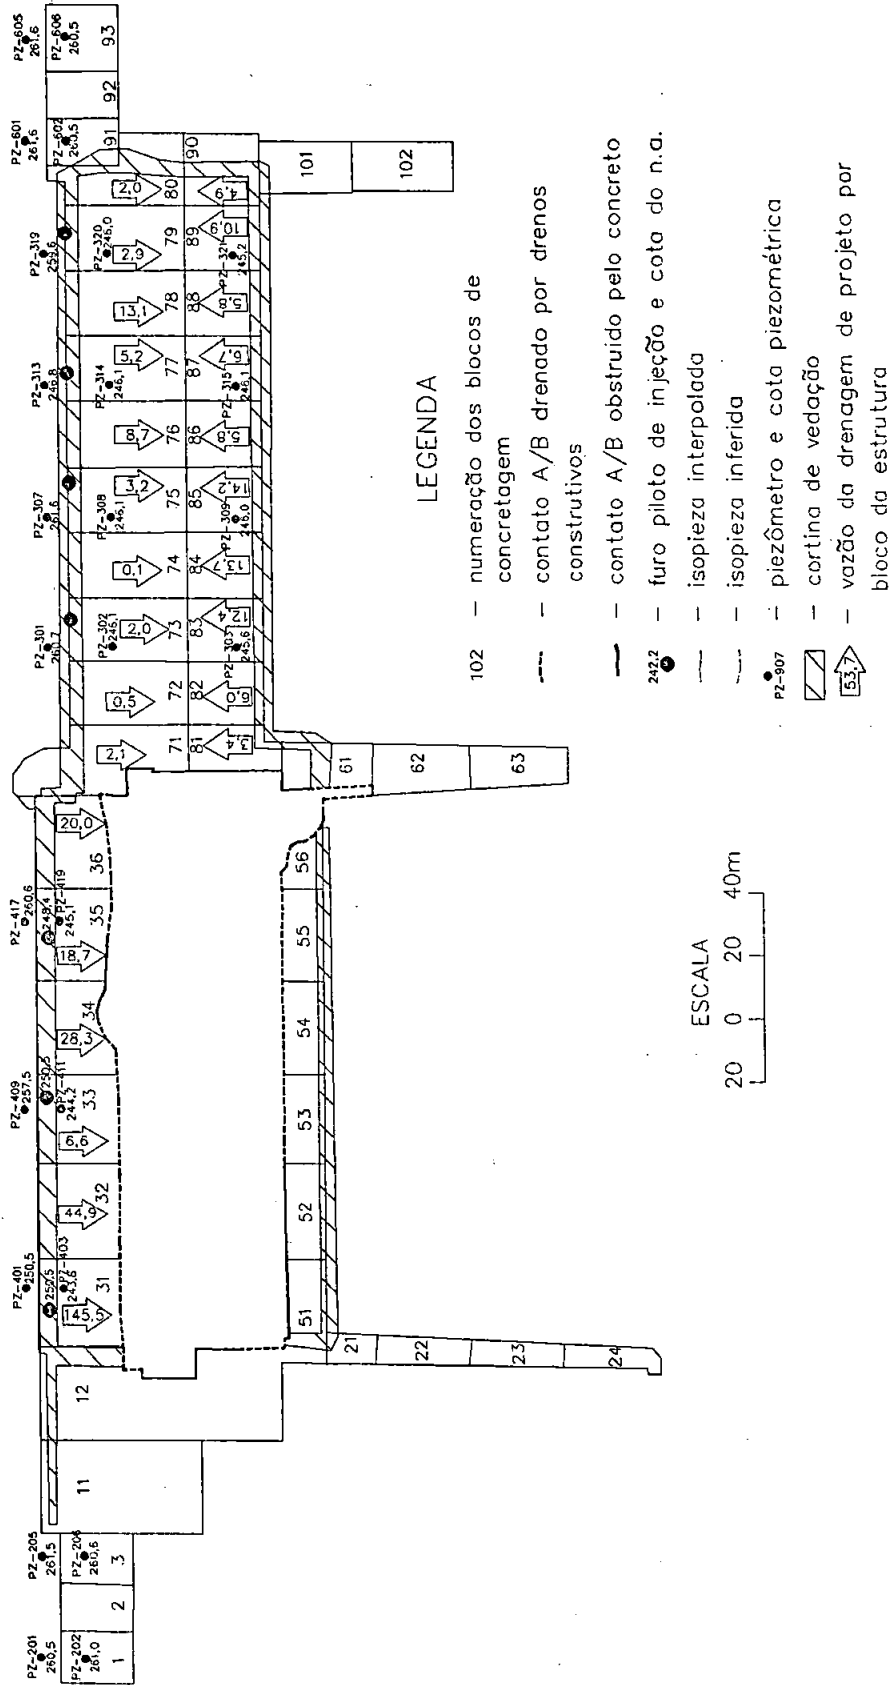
Planta piezométrica e vazões (l/min) por estrutura, após o enchimento da barragem
